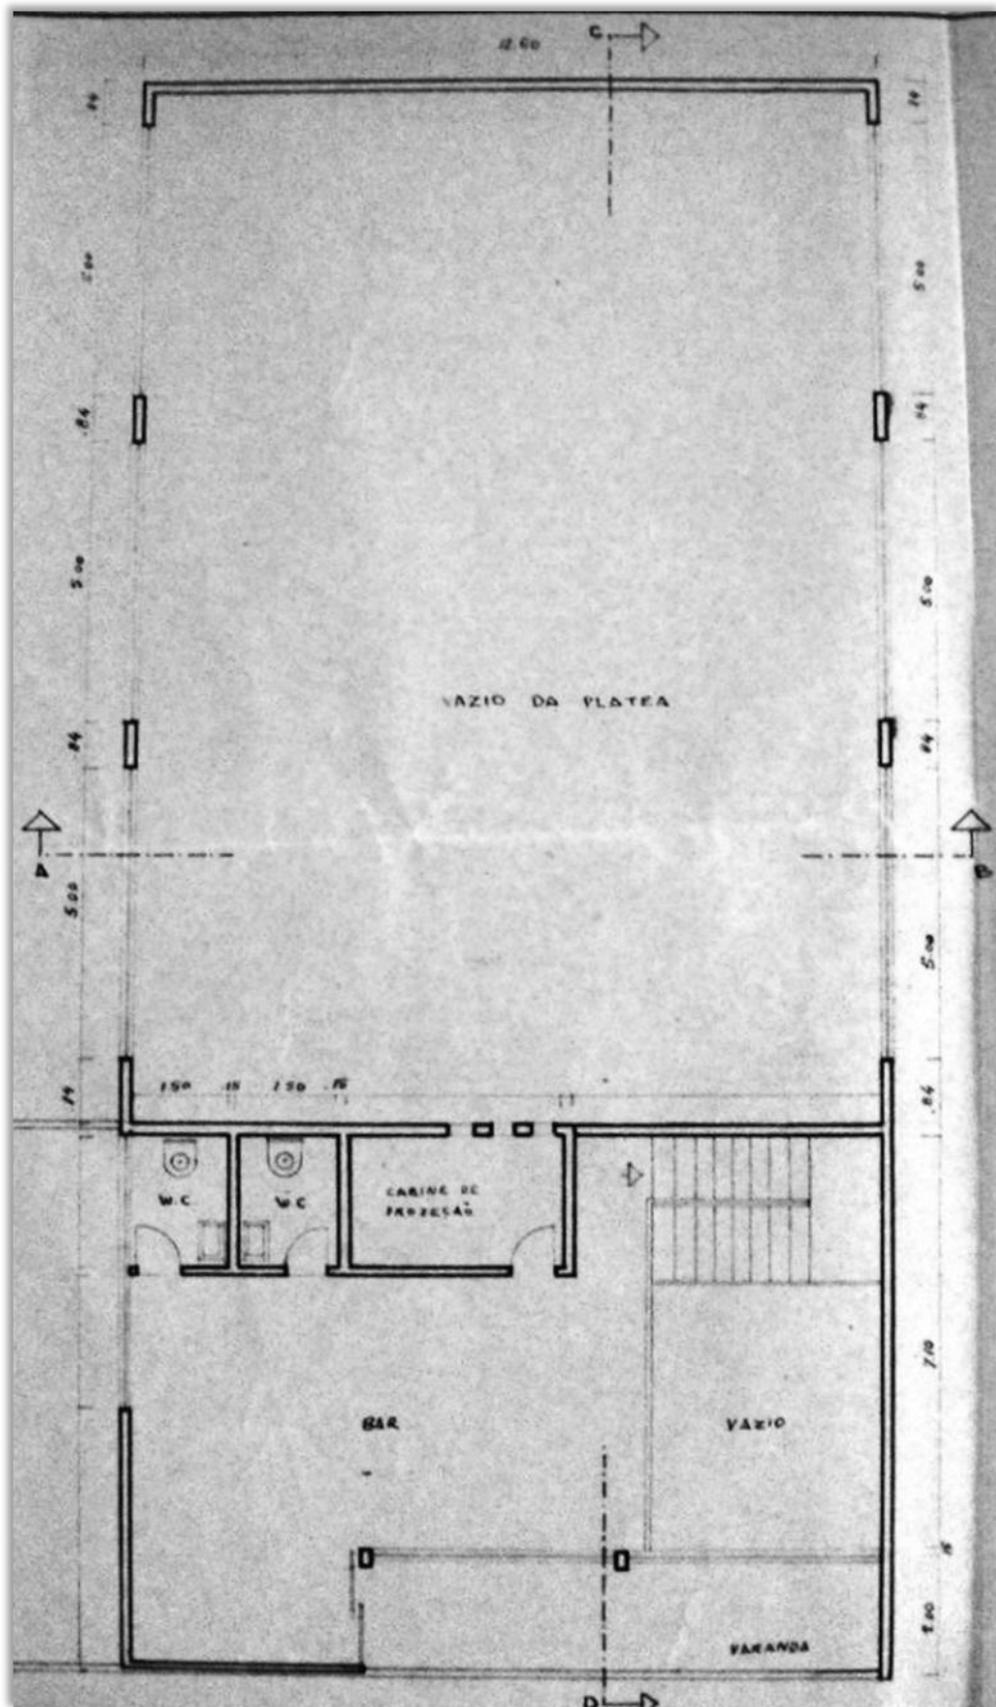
Projeto cinema, planta baixa pavimento superior.
